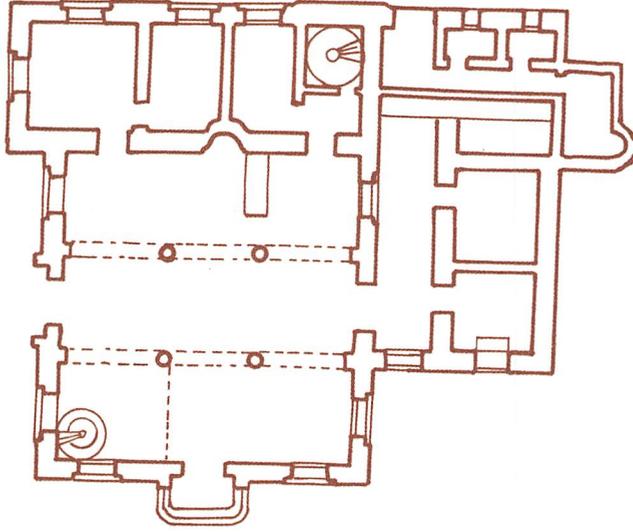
المسقط الأفقي لقبة وضريح القصر اوى بقراقص
